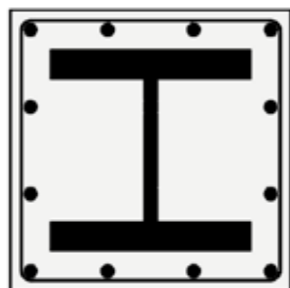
Типовое поперечное сечение железобетонной конструкции с жесткой арматурой, работающей на сжатие (колонны)
